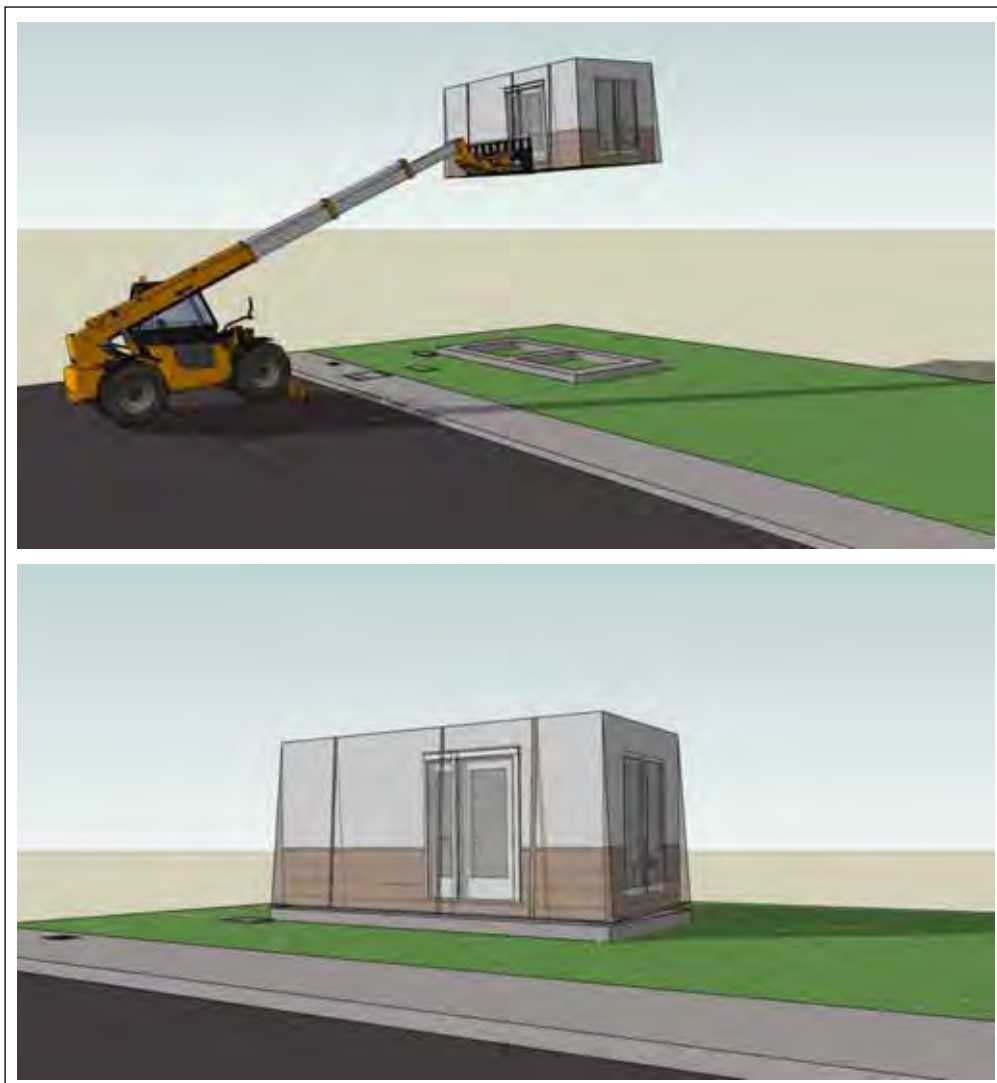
Colocación del módulo en sitio. Fuente: Elaboración propia
